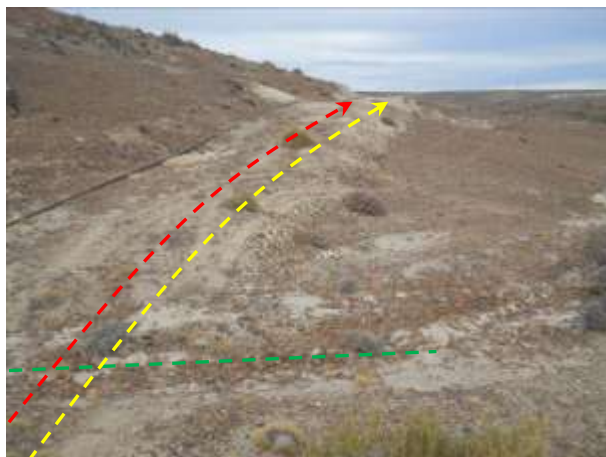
Se observa emplazamiento de ductos por picada parcialmente revegetada y cruce con drenaje efímero (verde). Vista de línea de conducción por misma picada. Foto en dirección SE.
